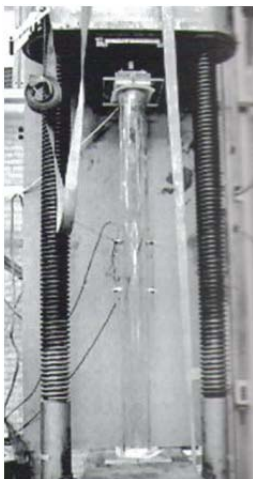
Porušení vrstvených skel různého druhu [8].
